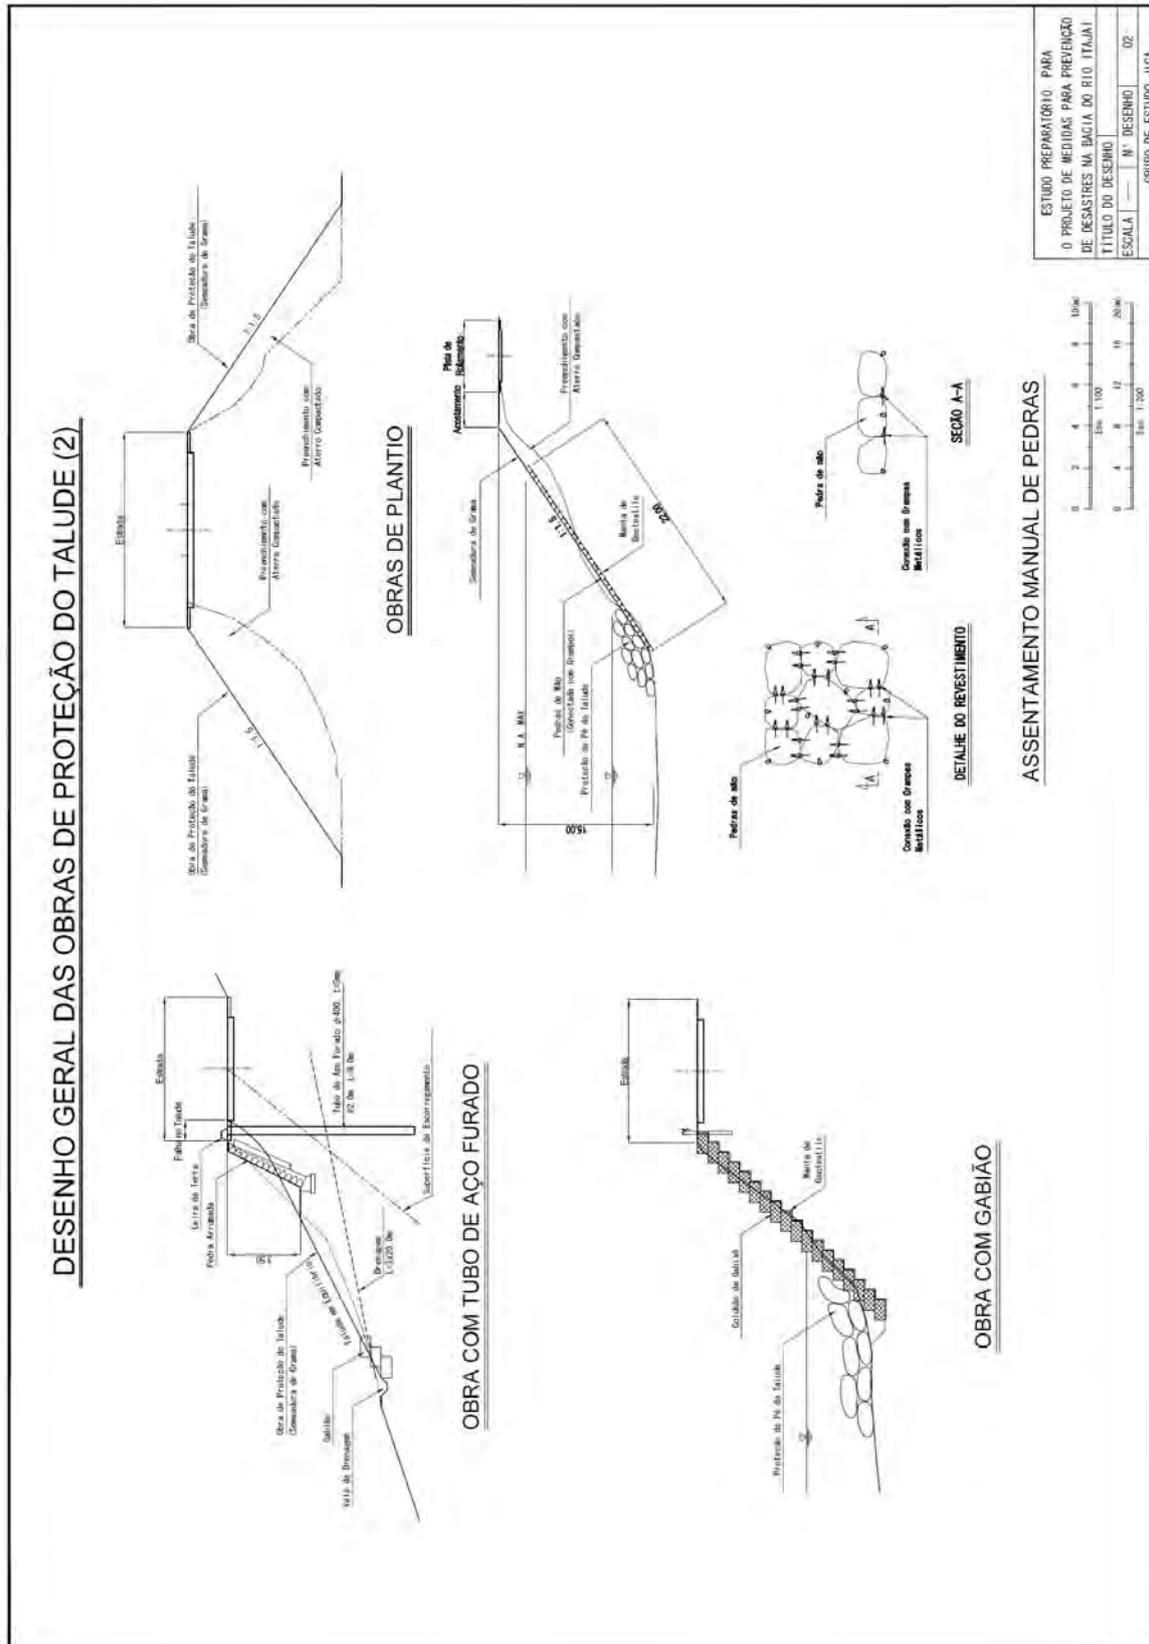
Projeto estrutural da obra de estabilização do talude (2)
